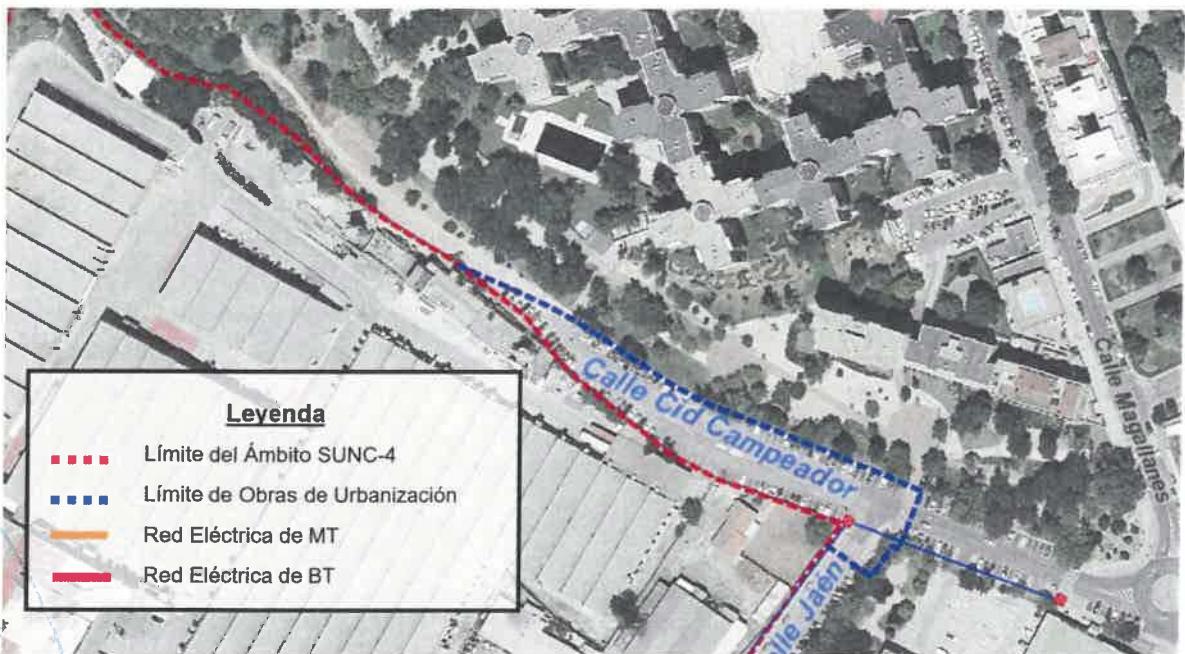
Vista de la red eléctrica de media y baja tensión en la calle Cid Campeador
